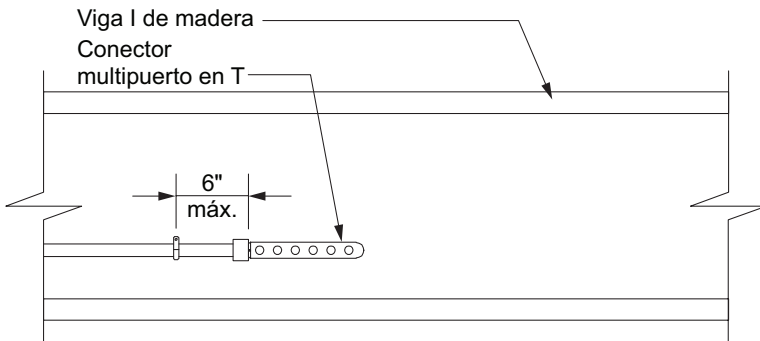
Apoyando a conectores multipuerto en T en vigas I de madera
